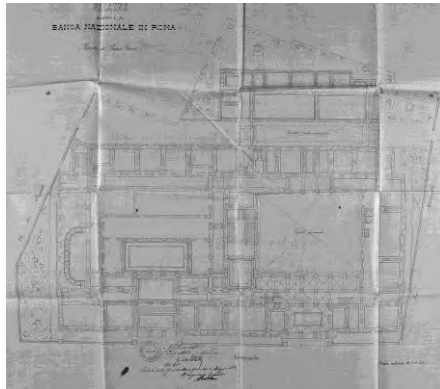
palazzo della Banca d'Italia pianta del piano terra, progetto
